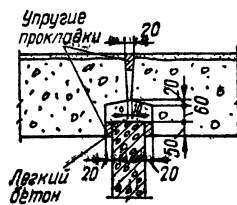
Вертикальные стыки наружных стеновых панелей.
